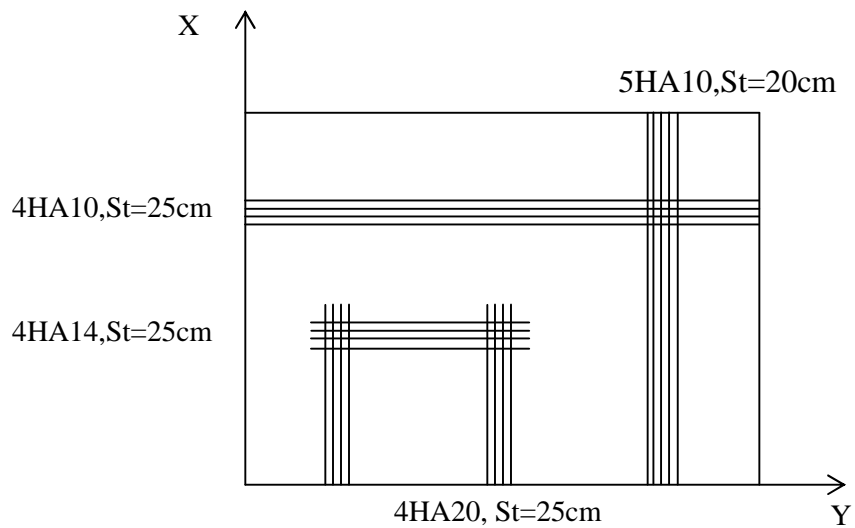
schéma de ferrailage de la dalle pleine type3.
